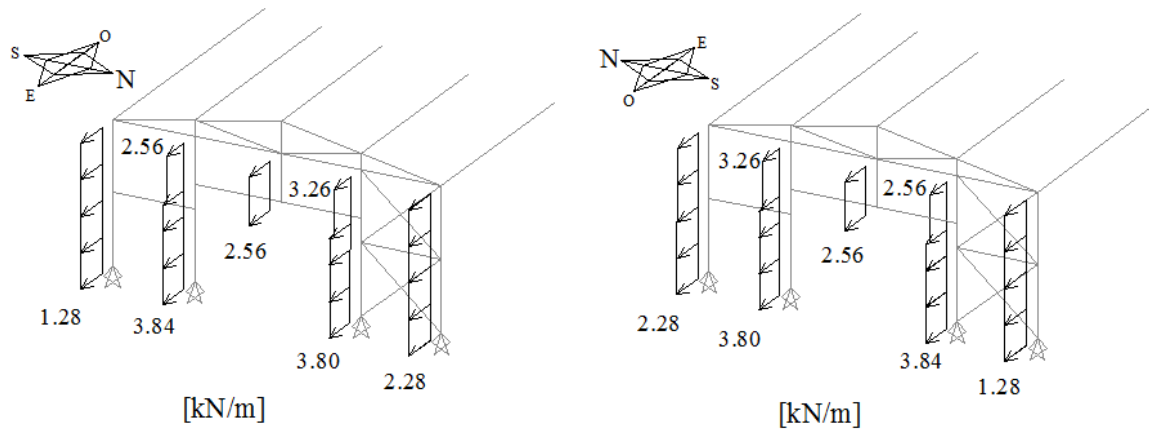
Vento W1 nas fachadas orientadas a Oeste e Este na situação 2 (EC1.1.4)
